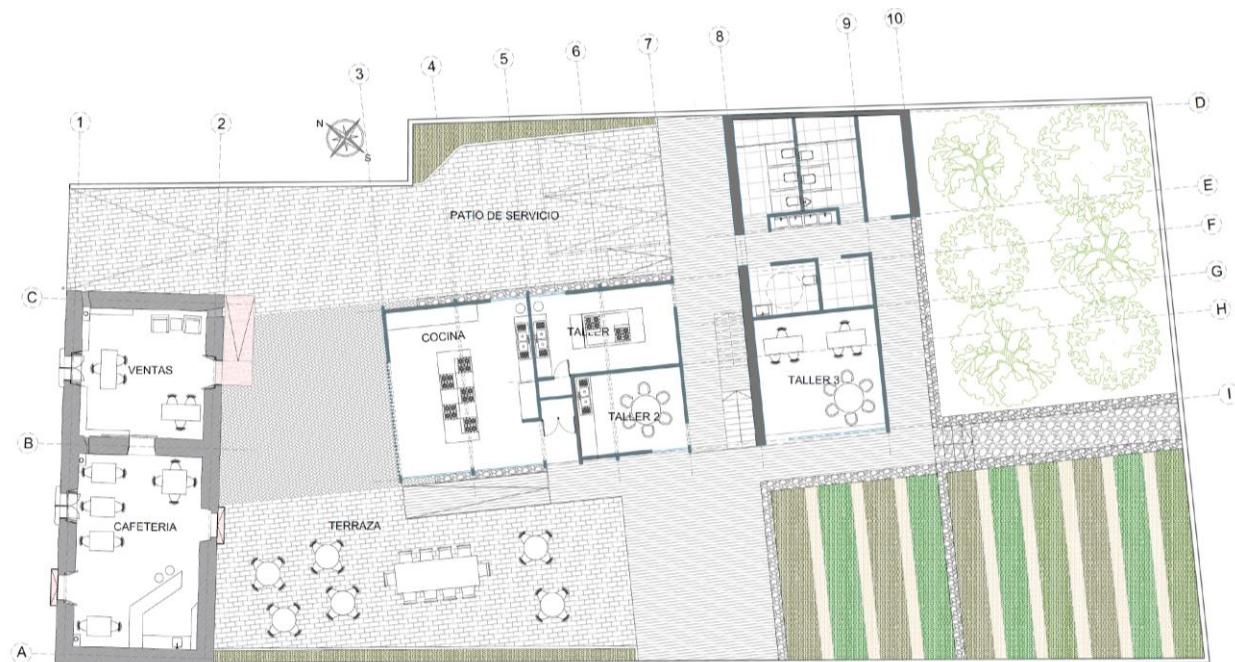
Plano de conjunto, sin escala. Elaboración propia
